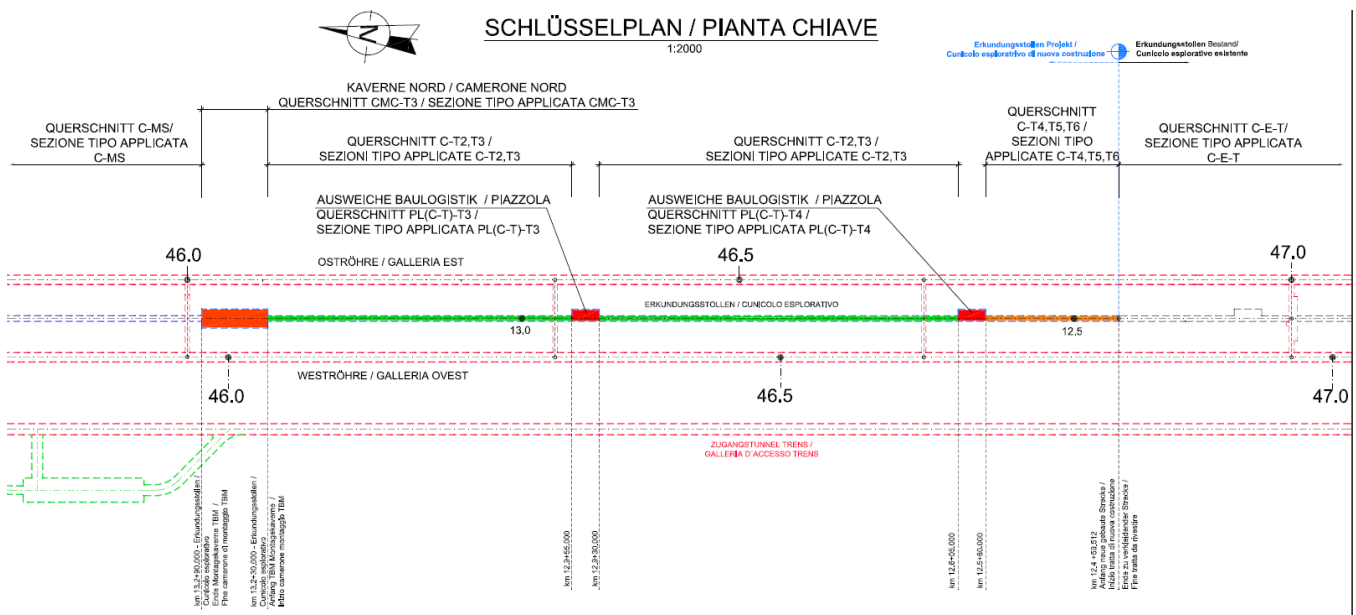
Planimetrisches Schema der konventionell vorzutreibenden Erkundungsstollenstrecke.
